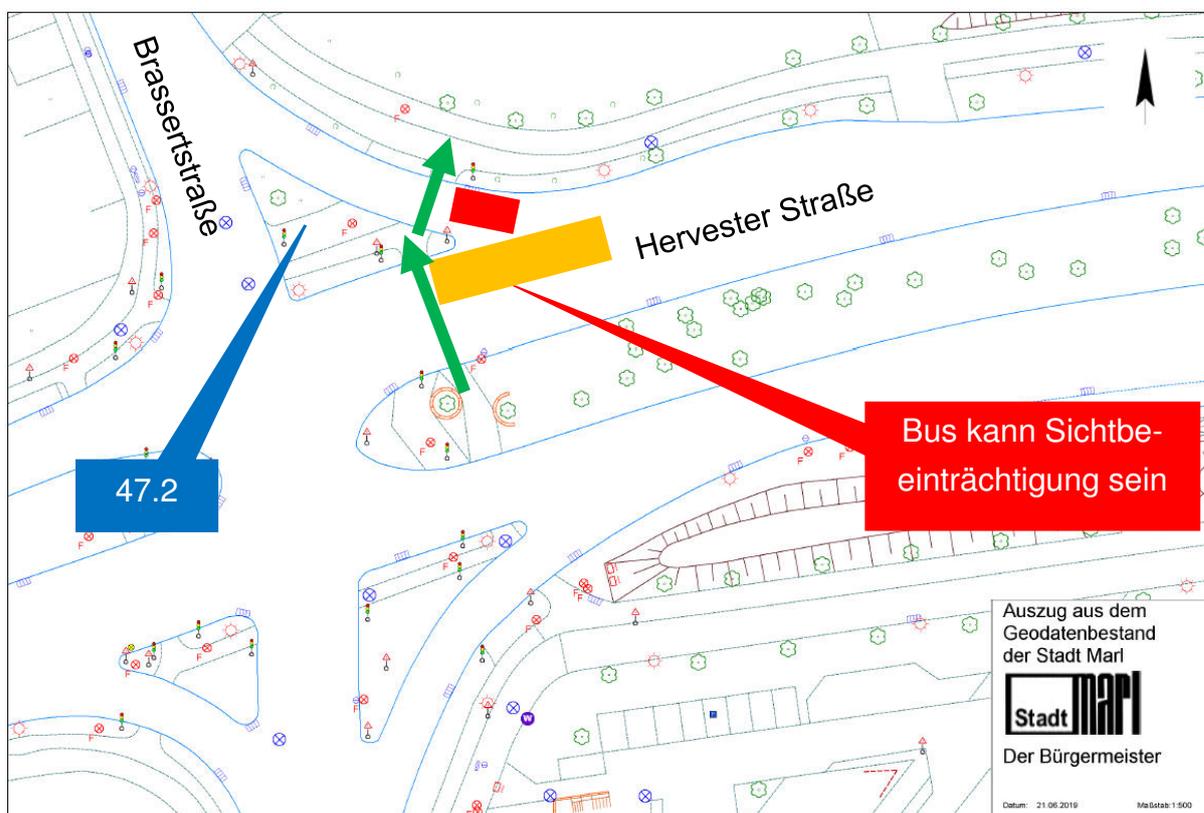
47.2 – Lageplan – Sichtbehinderung durch Bus
